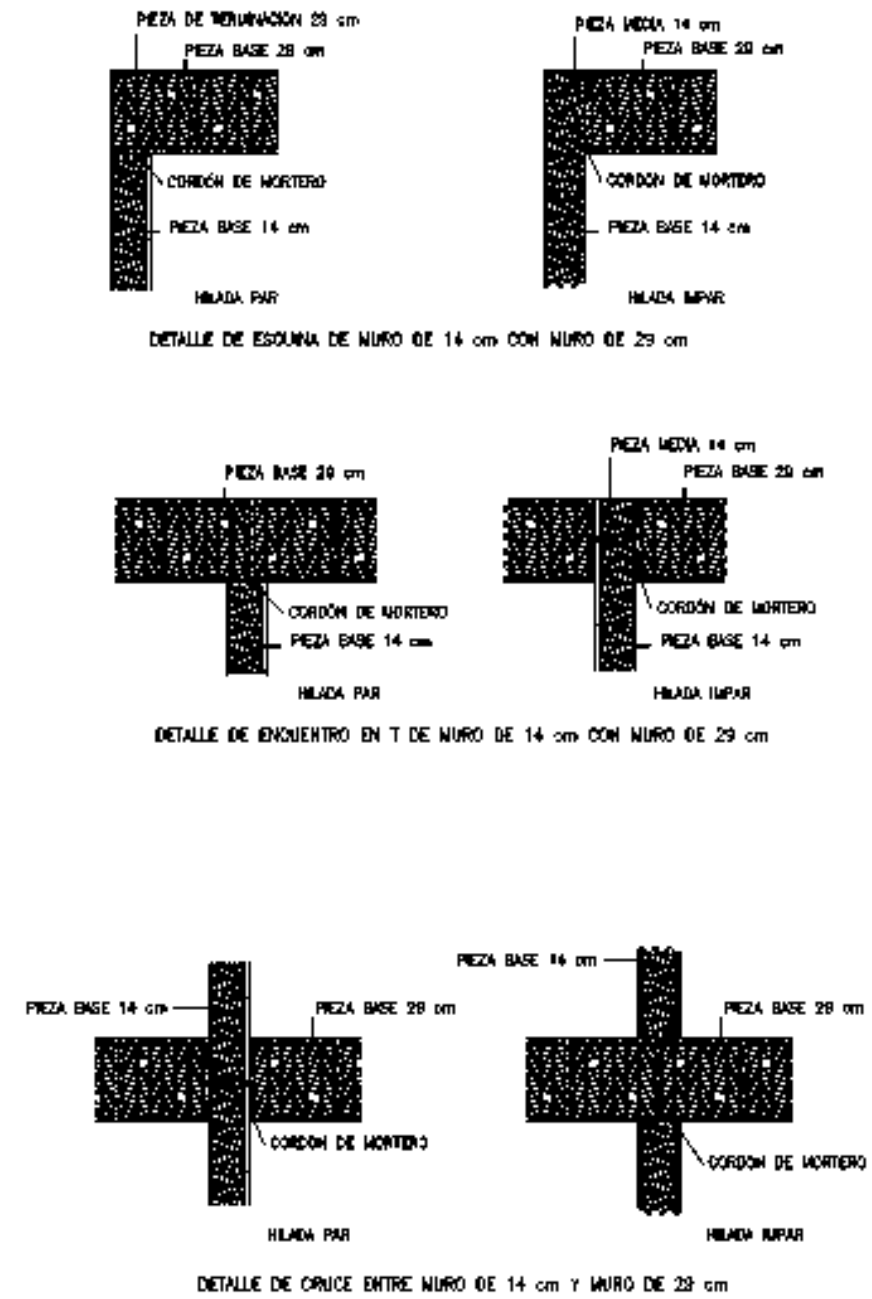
Detalles de encuentro de piezas de 14 cm con piezas de 29 cm
